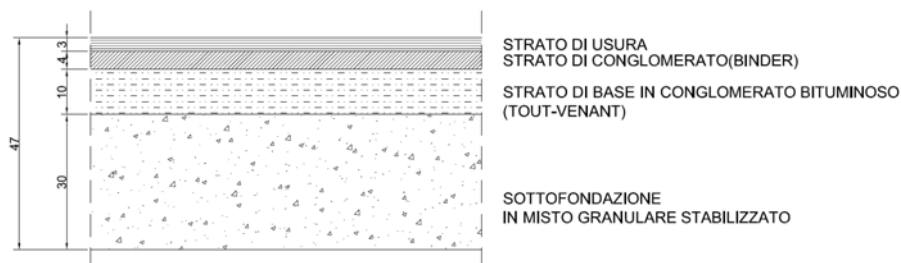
sezione tipo particolare pavimetnazione tratte di nuova ealizzazione e allargamenti sedimi stradali esistenti
